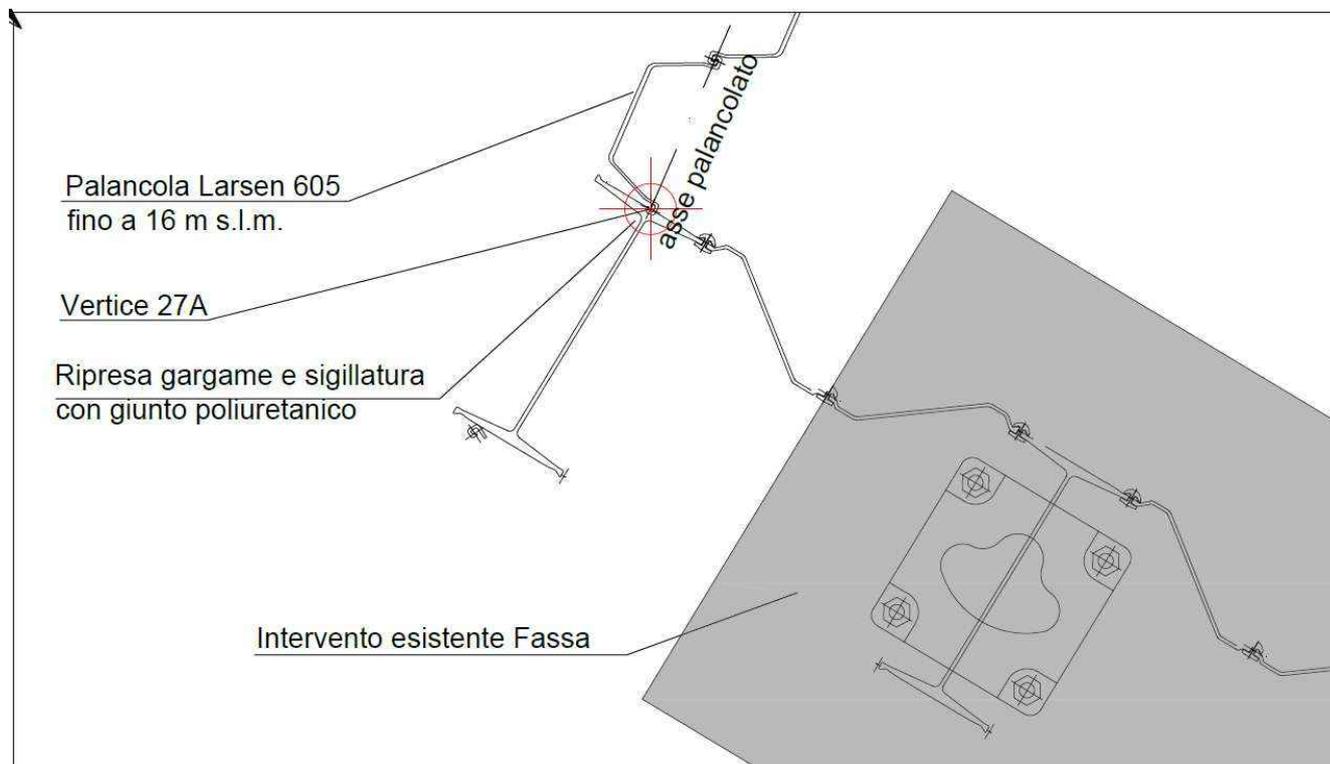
connessione marginamento area Fassa con diaframma di progetto
